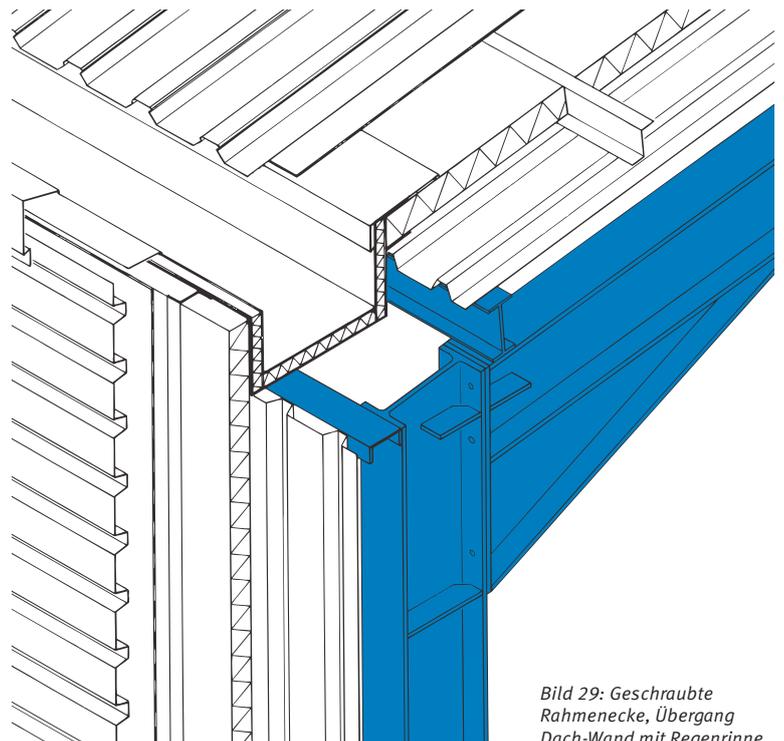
Geschraubte Rahmenecke, Übergang Dach-Wand mit Regenrinne
